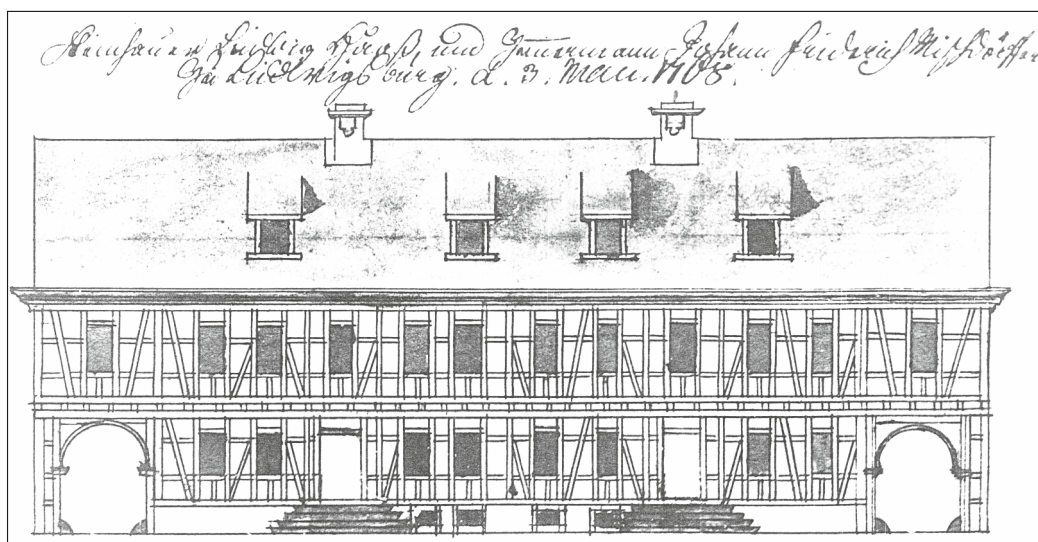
Plan Nr. 12, Reihenhaus mit vier Wohnungen pro Geschoss, Satteldach, zwei Durchfahrten, geplant 1768.
